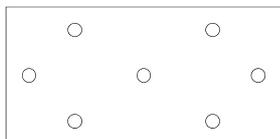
Plans de chevillage - panneaux de dimensions 1000 x 500 mm
